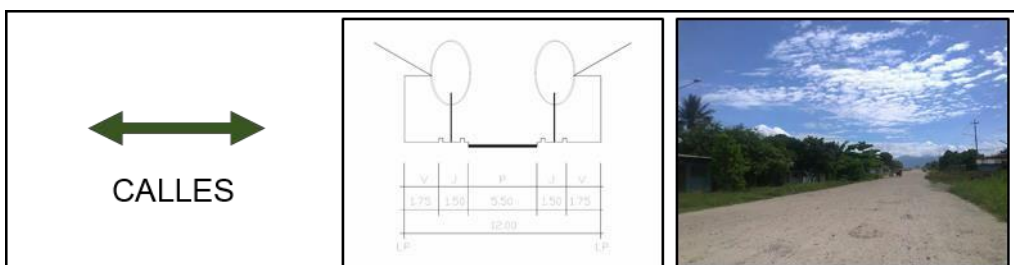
Dimensiones de la Calles, Fuente: Autor de Tesis
